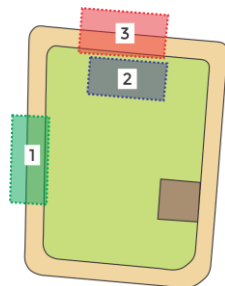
Site Plan Sebelum Direnovasi (2013)
